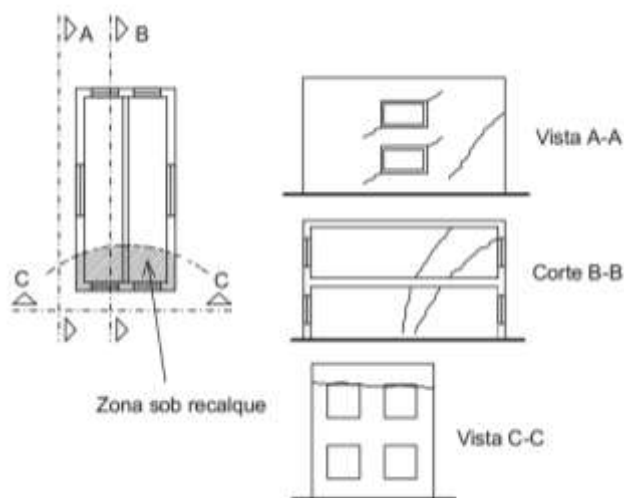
Configuração típica de fissuras causadas por recalque de fundações segundo um eixo principal
